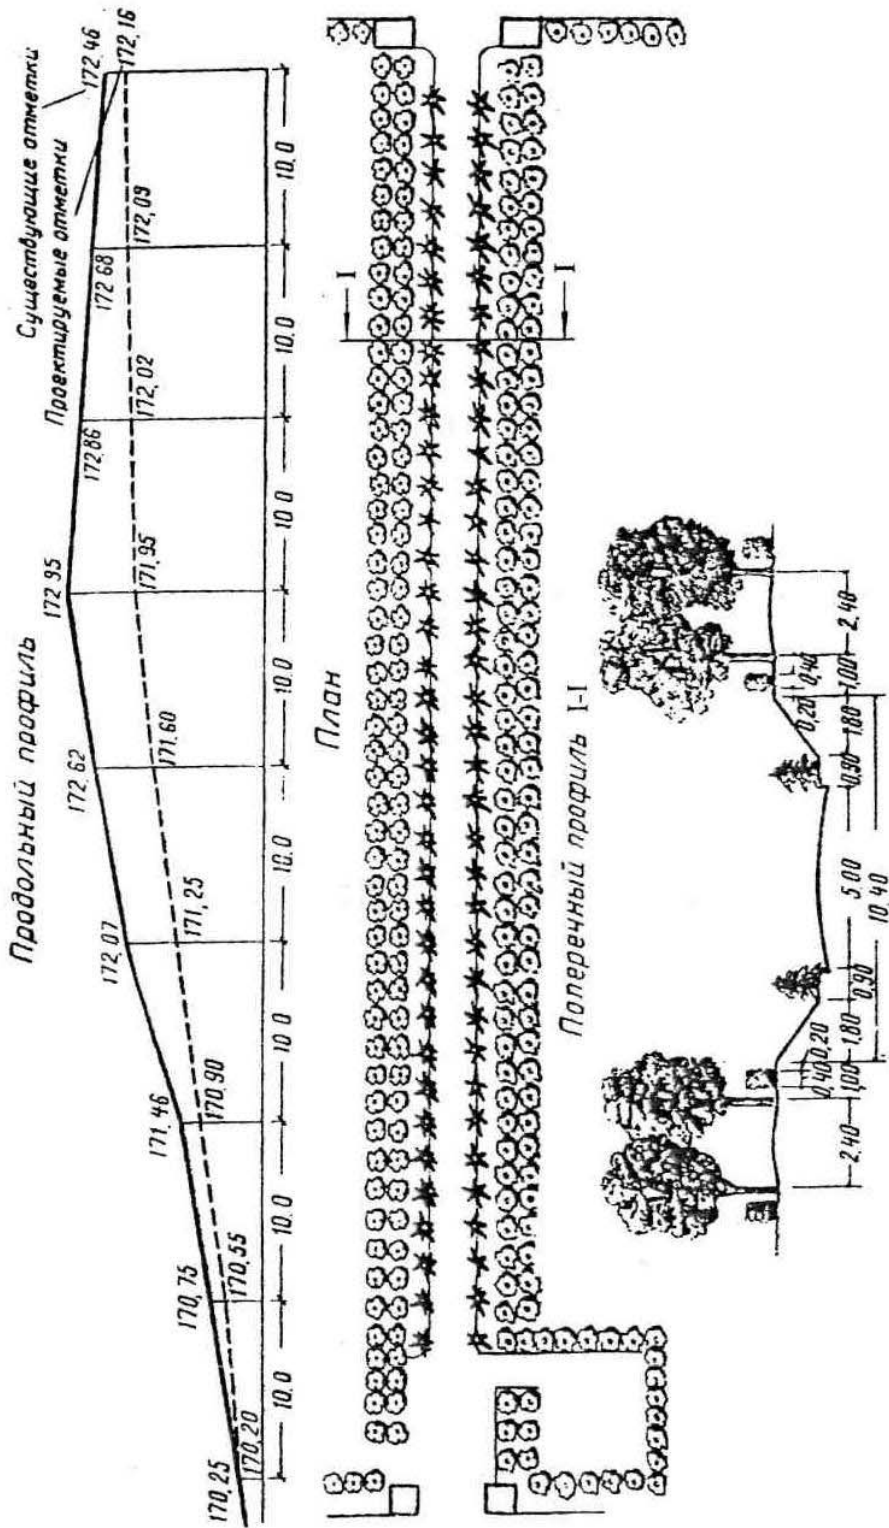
Пример построения продольного профиля участка бульвара: продольный профиль строится сечением через каждые 10 м. Приводится планировка бульвара и поперечный разрез (по материалам Л.Б. Лунца)
